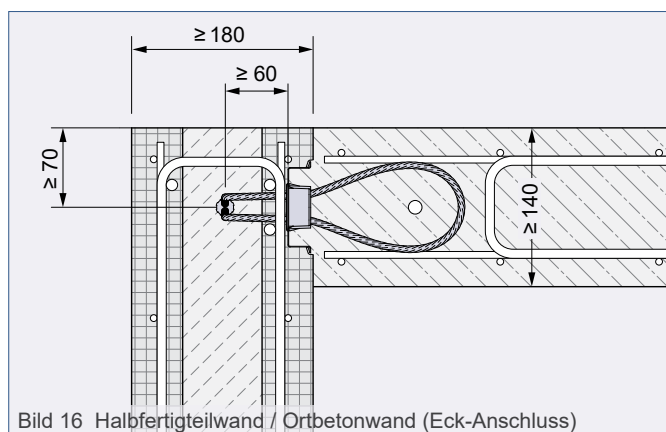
Halbfertigteilwand / Ortbetonwand (Eck-Anschluss)
